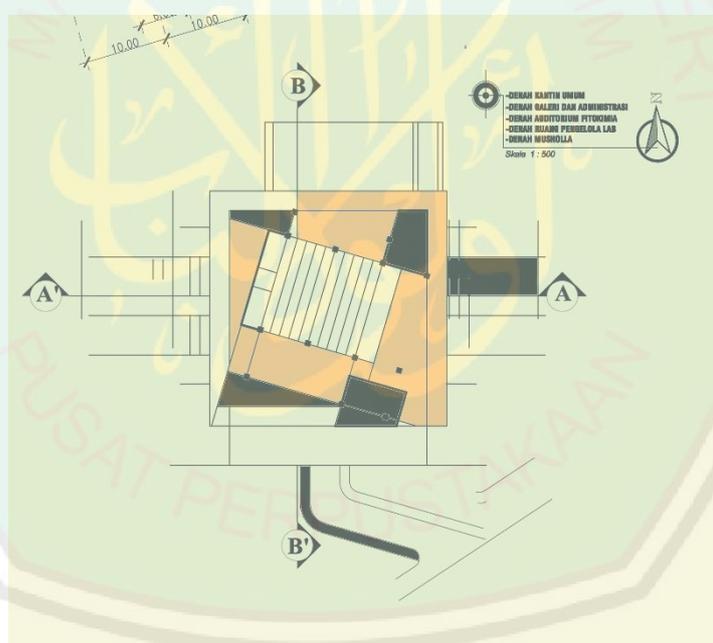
Denah Laboratorium Pasca Panen dan Terpadu
